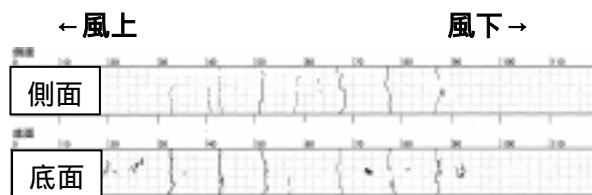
加熱後のひび割れ(2 時間加熱)
